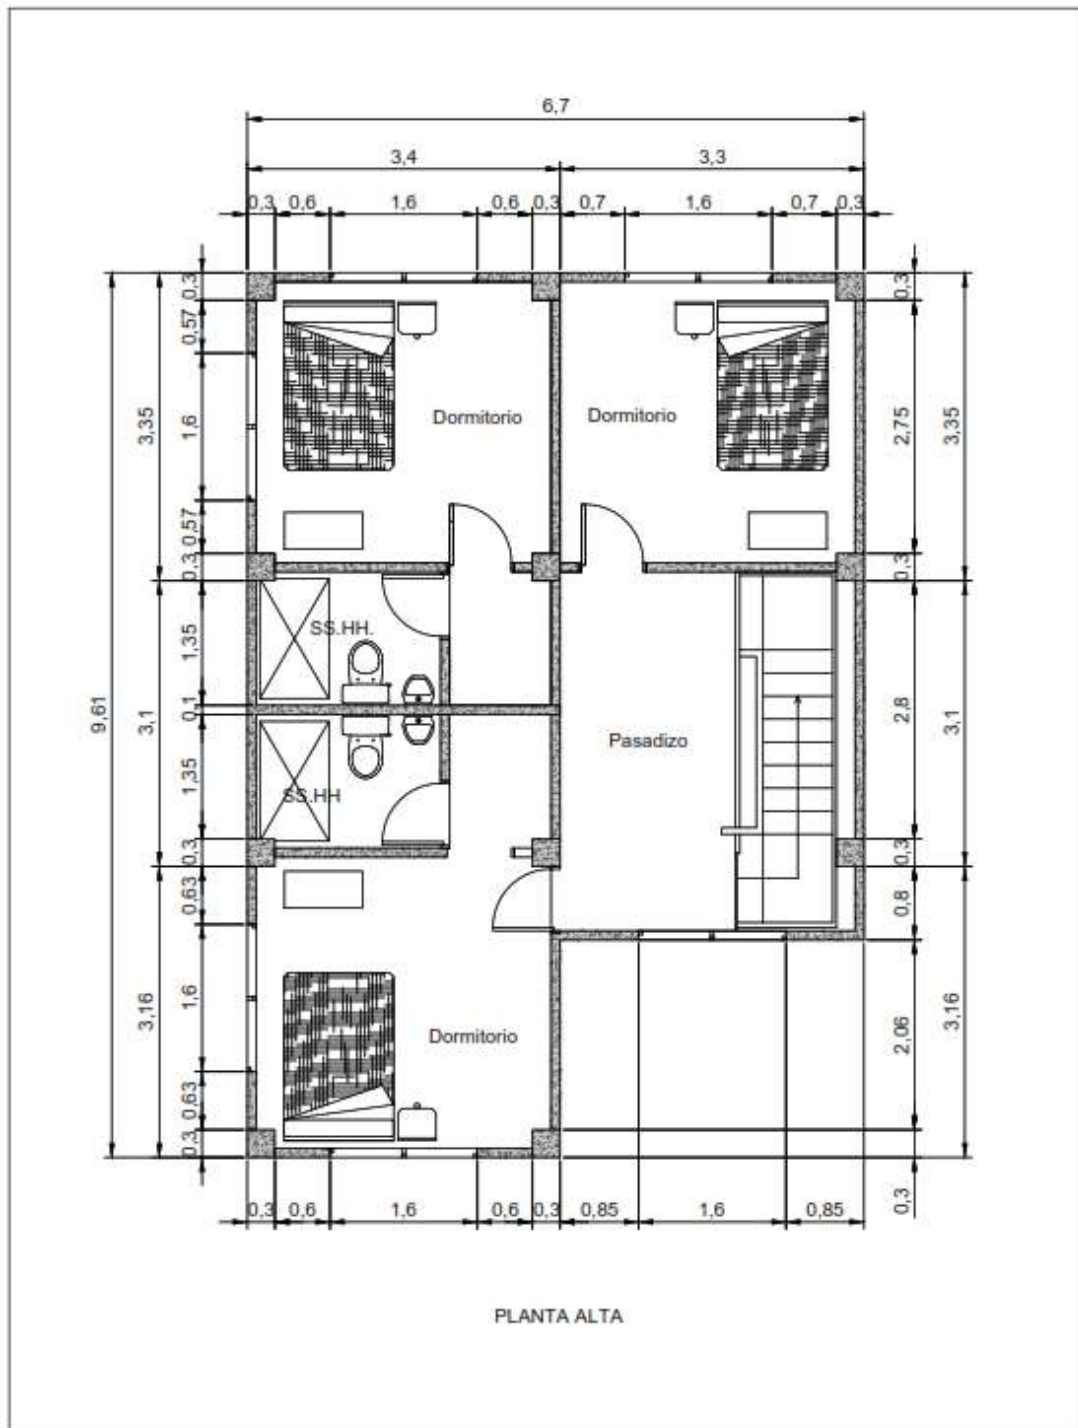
Planta de Arquitectura segundo nivel de 56,57 m² (sistema constructivo tradicional).
